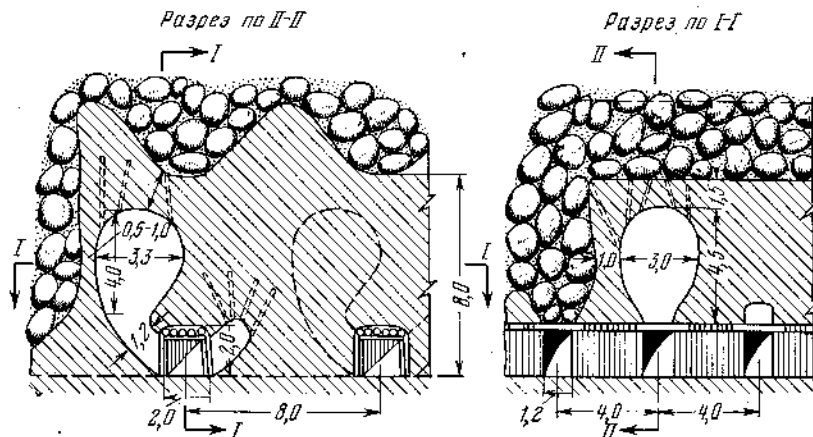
Подэтажное обрушение — вариант наклонных грушевидных заходок
